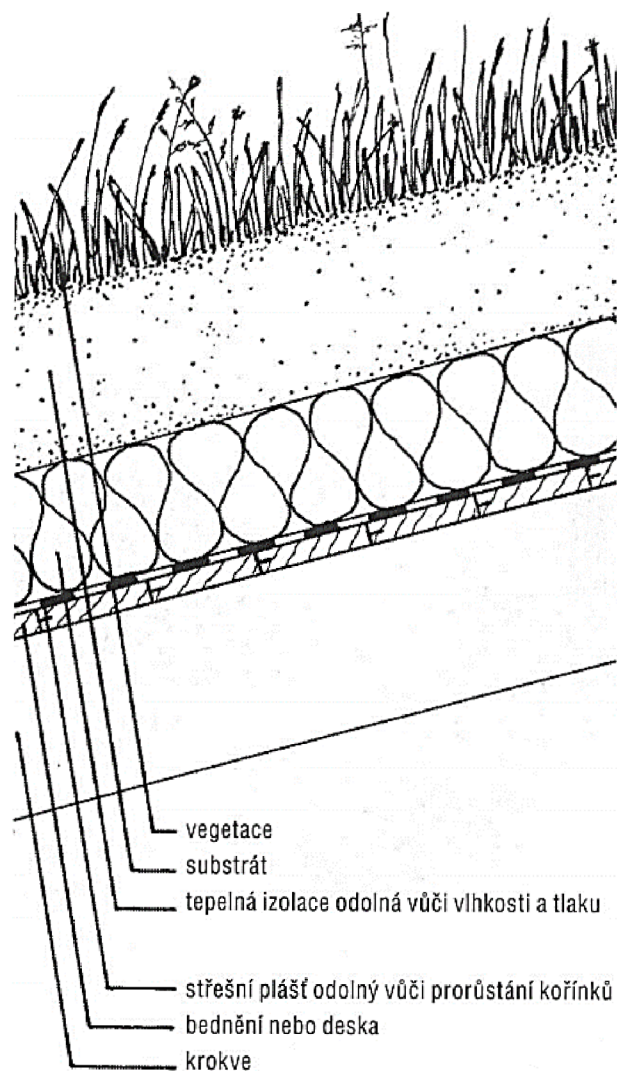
Typická konstrukce teplé střechy s ozeleněním [5]
